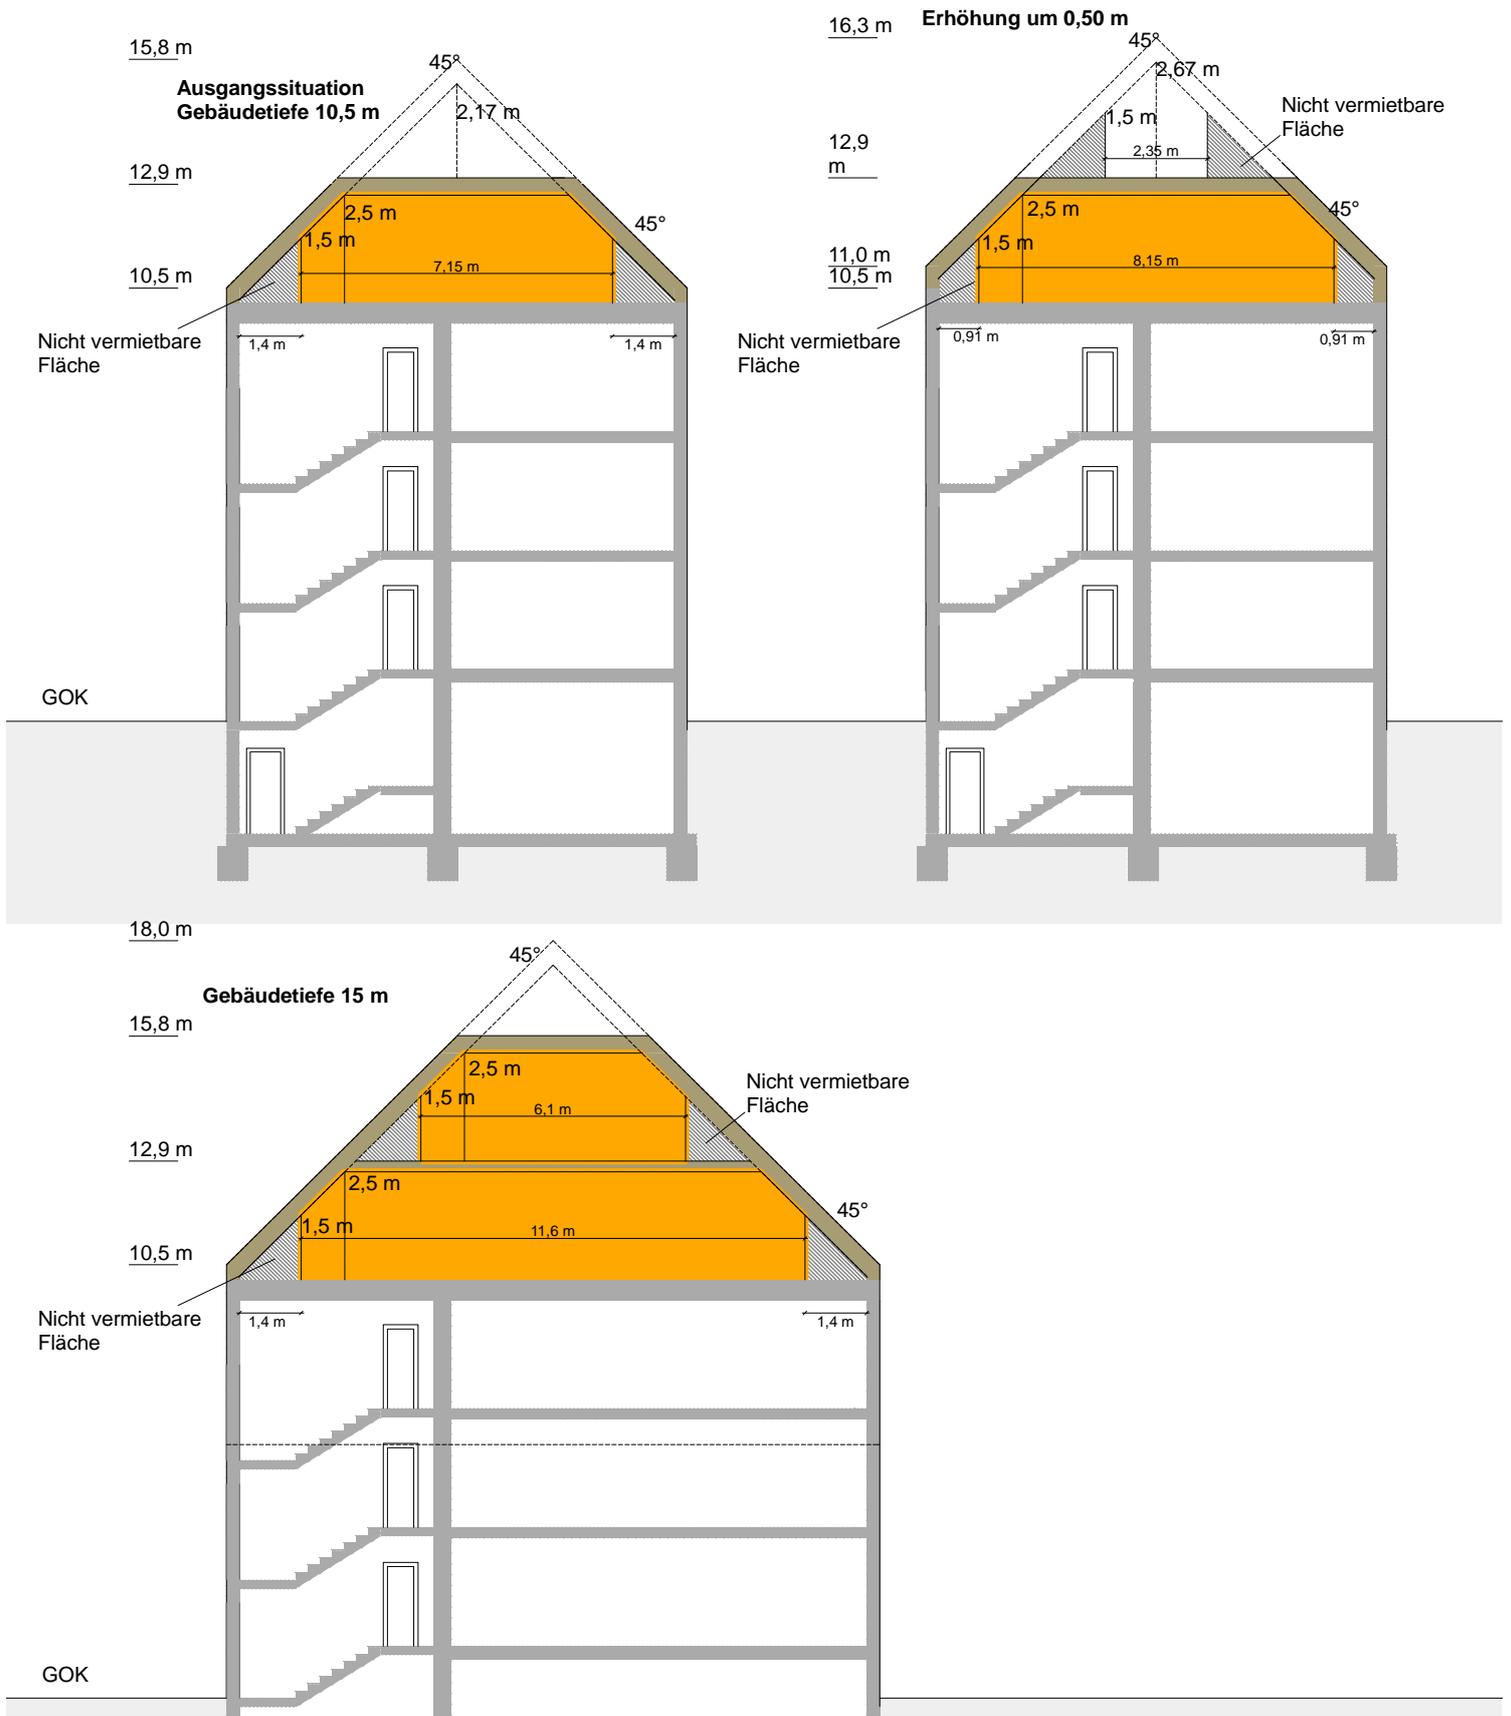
Vergleich verschiedener Varianten des Dachgeschoßausbaus M 1:250 [Quelle: eigene Darstellung]
